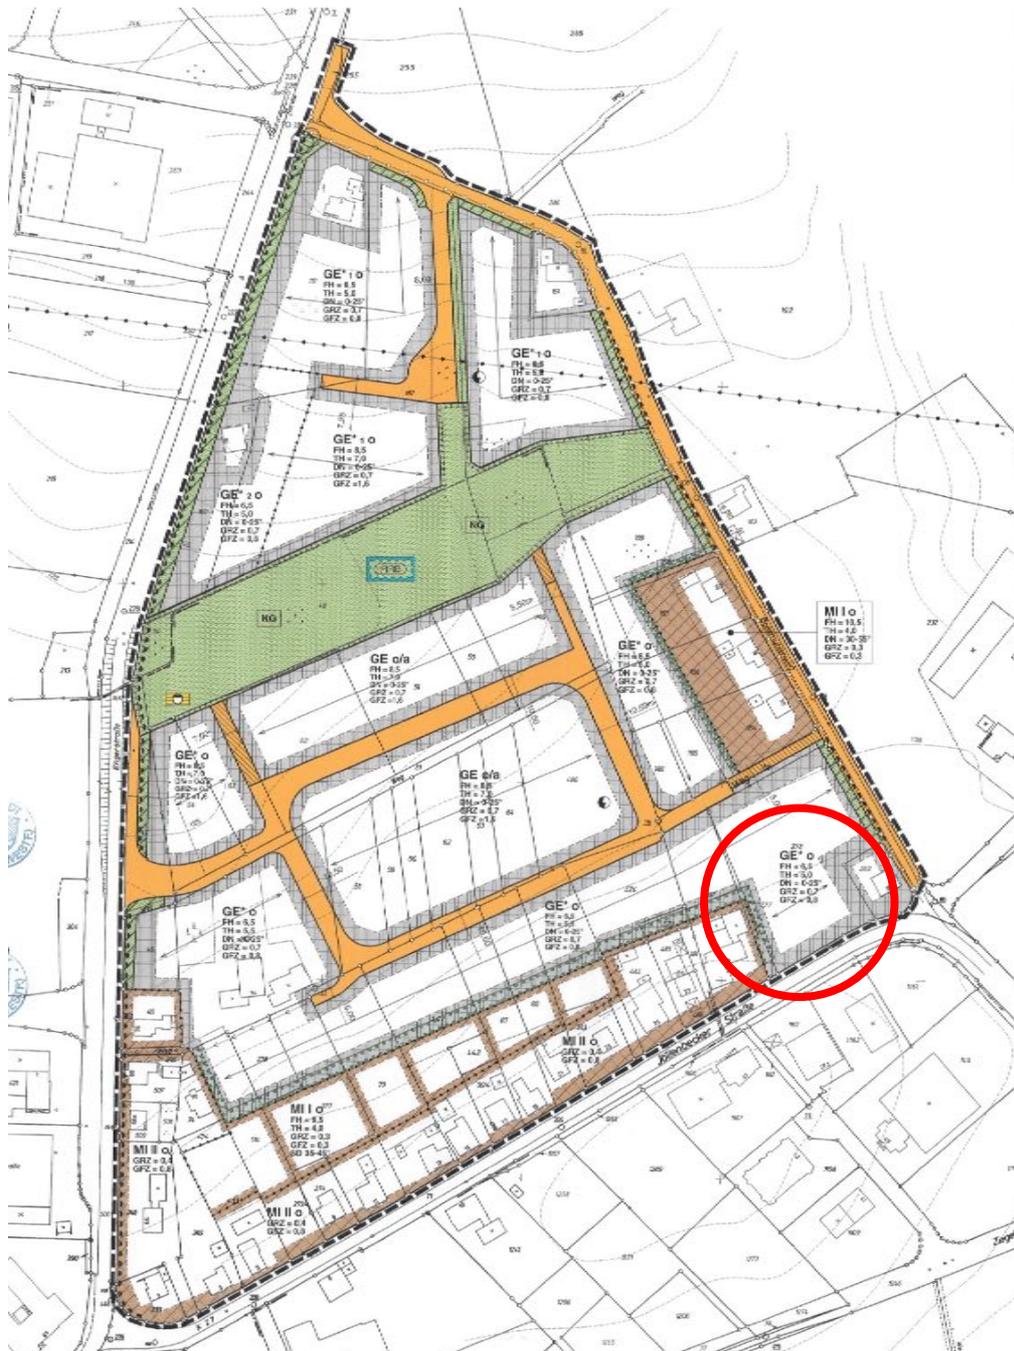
Planzeichnung des Ursprungsplans aus dem Jahr 2004 mit Änderungsbereich (unmaßstäblich)
